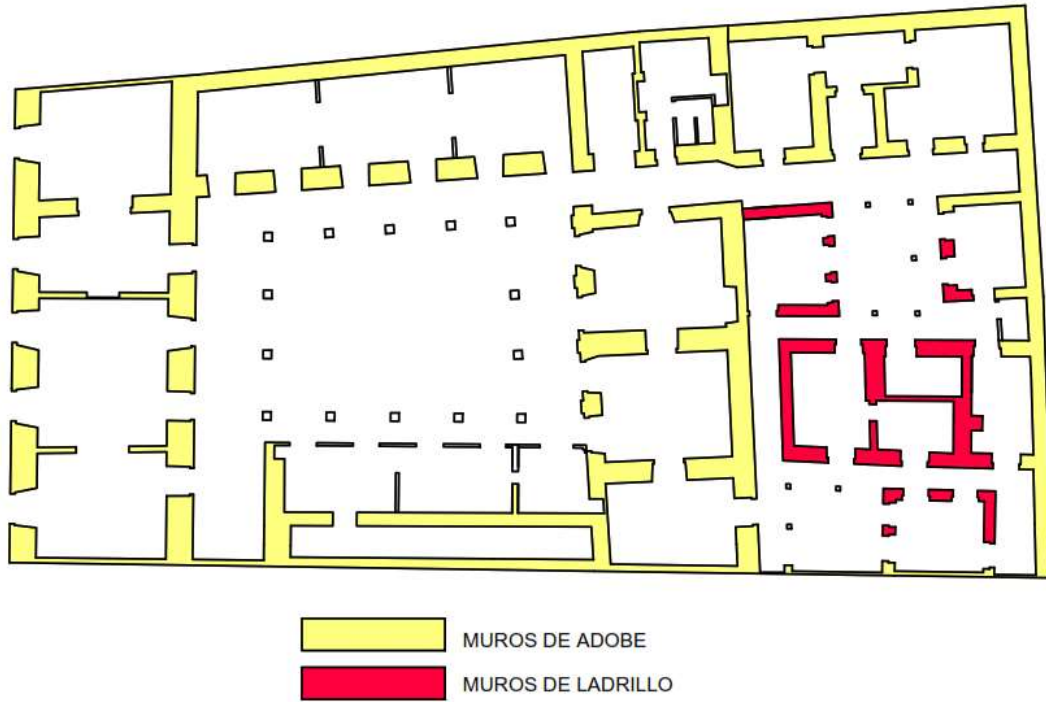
MUROS ESTRUCTURALES PLANTA ALTA
